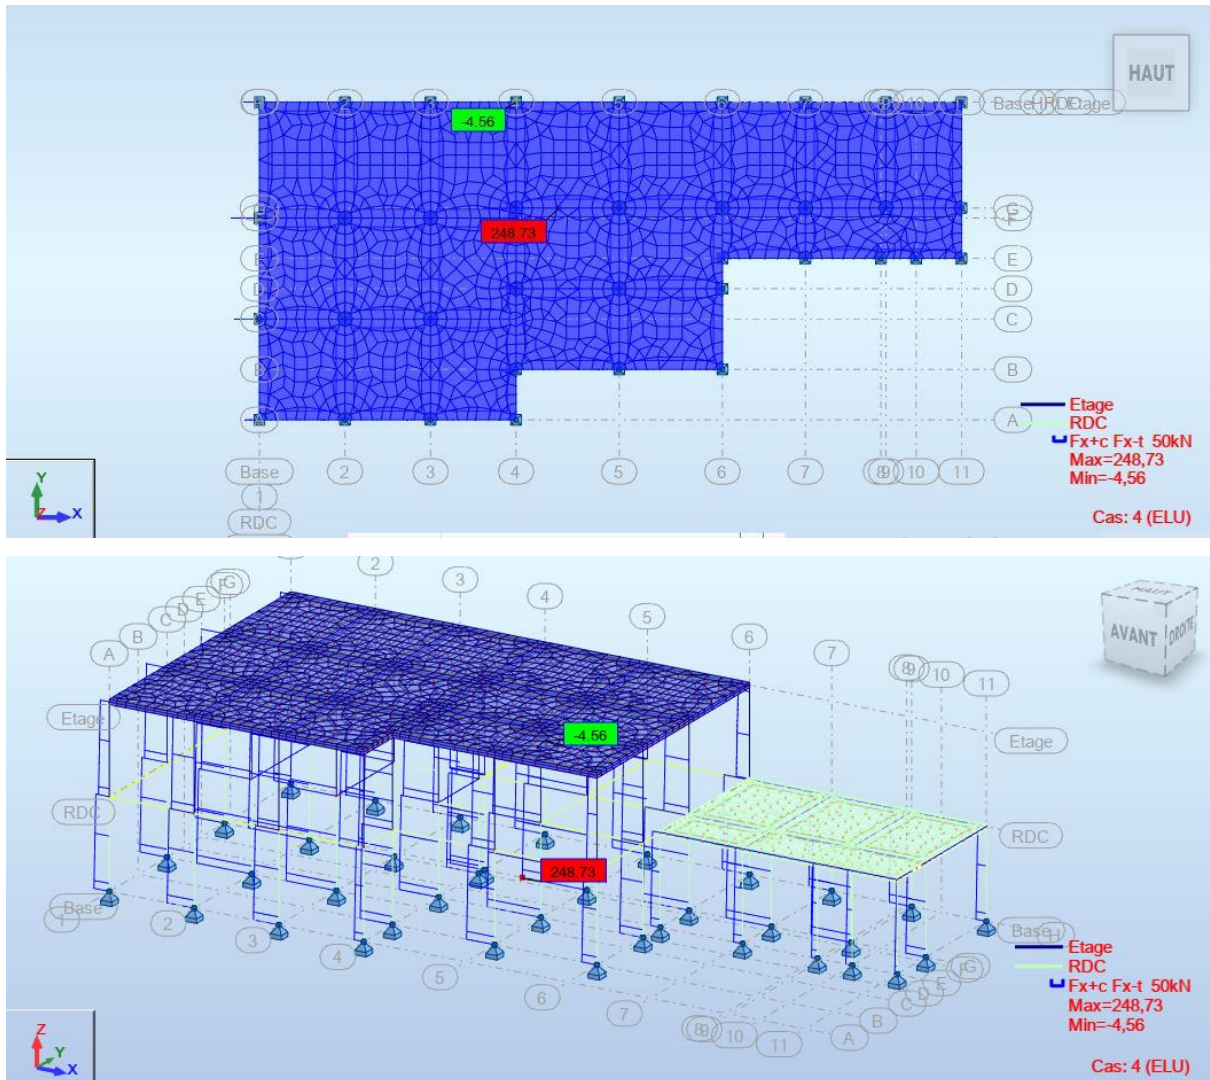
Le poteau le plus chargé de l'ouvrage
